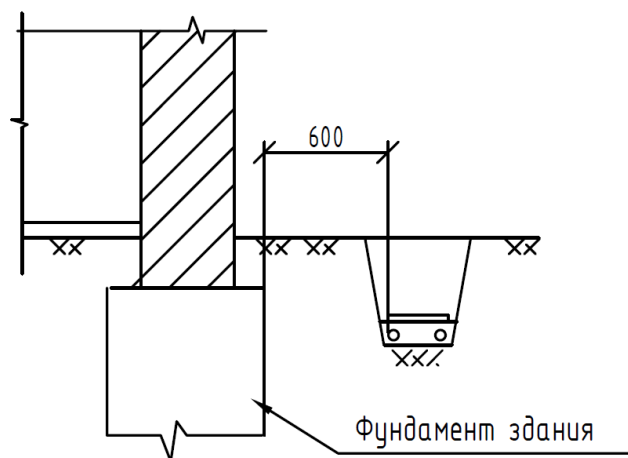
Внешний вид прокладки кабеля в траншее параллельно фундаменту здания
